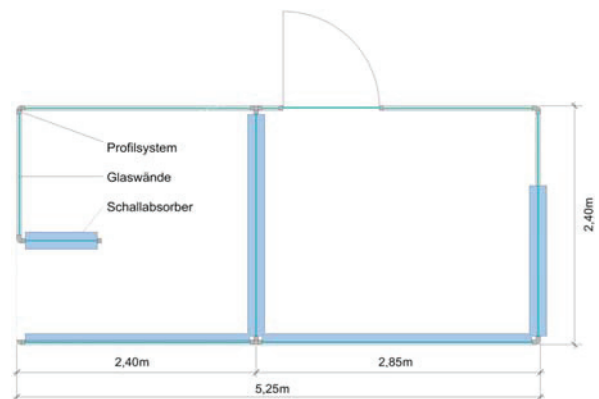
Zeichnung (Grundriss) des für die überschlägige Bilanzierung verwendeten Raum-in-Raum-Systems
